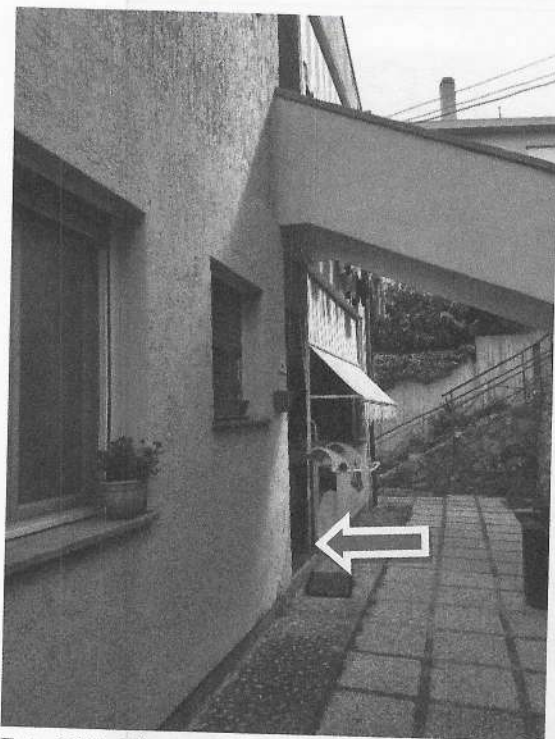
Vista della corte comune, antistante l'ingresso alla abitazione al Piano terra.
